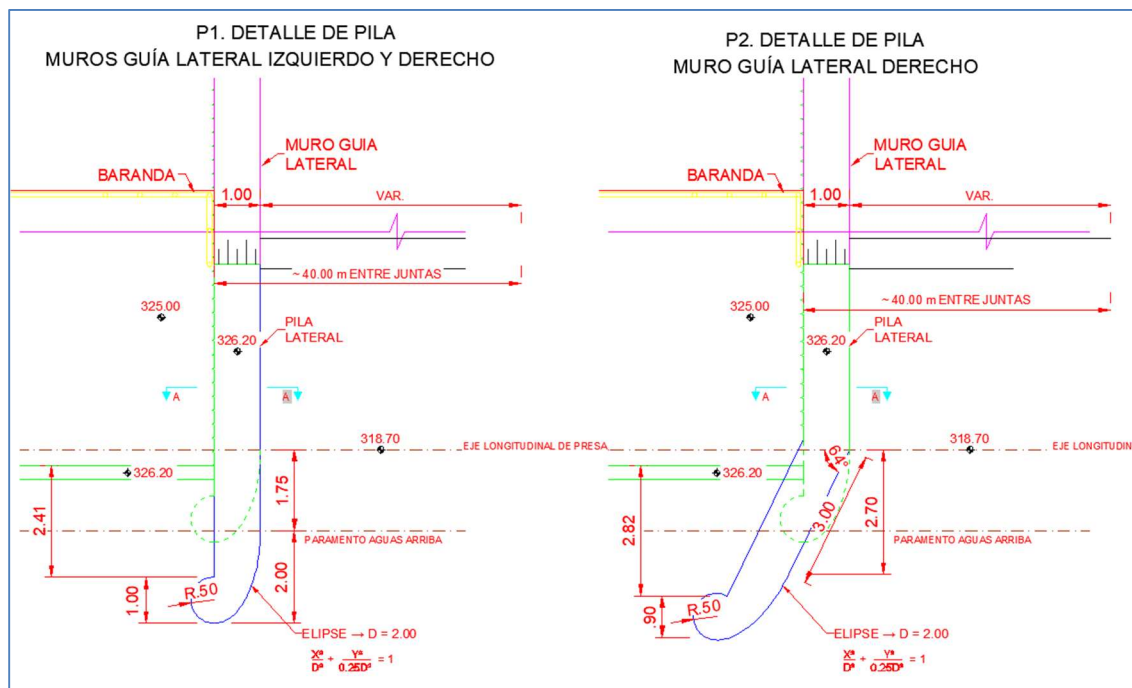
Propuesta para modificar la geometría de las pilas extremas
